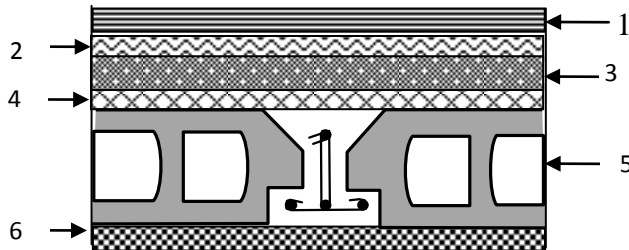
Coupe transversale dans Le plancher terrasse inaccessible.
